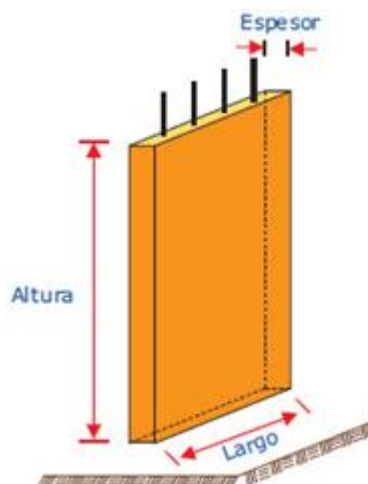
Ejemplo de muro de corte.²⁵
